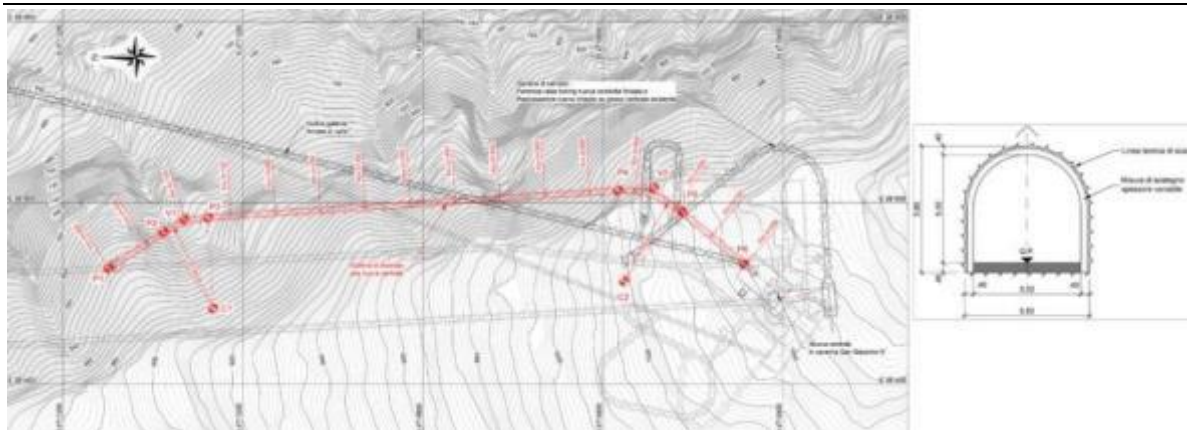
Galleria di accesso alla nuova centrale in caverna – pianta e sezione tipo
